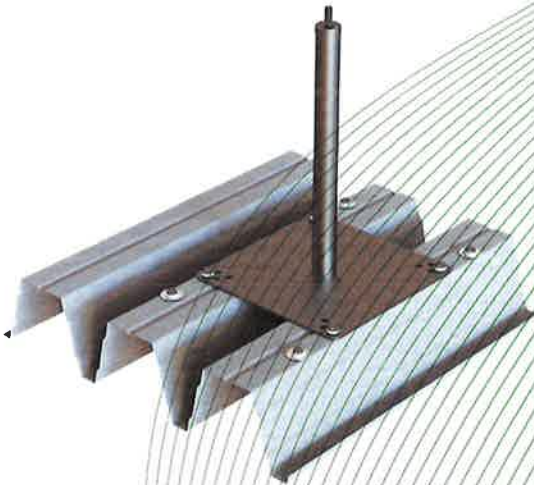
Anschlageinrichtung, Typ: SAFEX VARIANT TR-II montiert auf einer Stahltrapezprofiltafel
